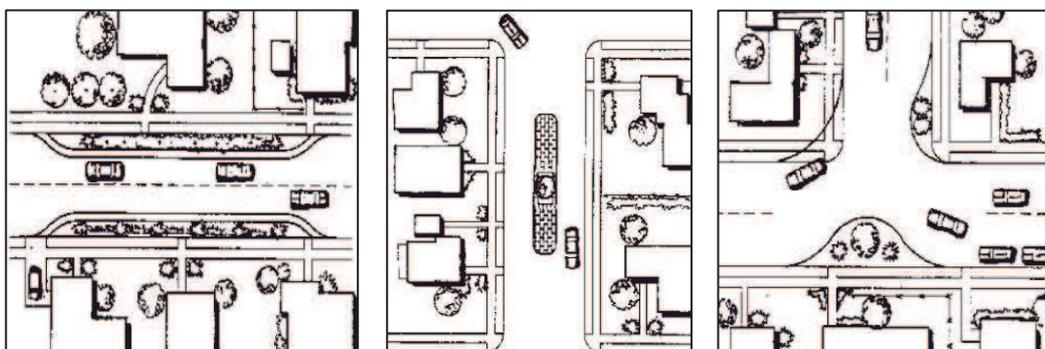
Estrechamientos, isletas separadoras y modificación de intersección en T.
